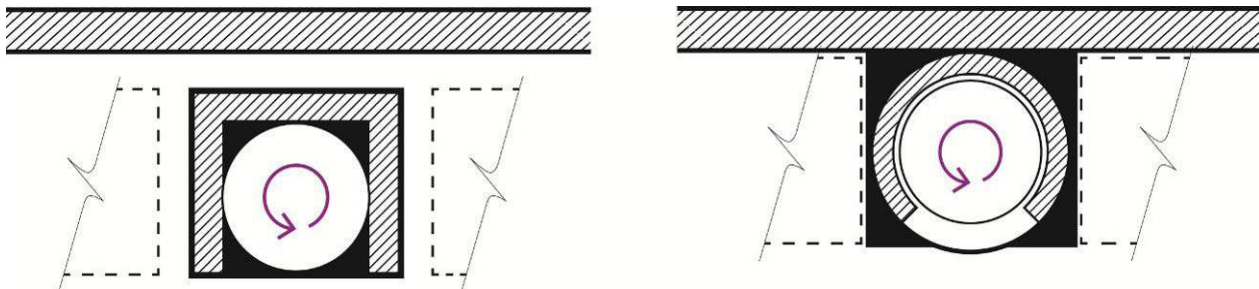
Nutzbarer Innenraum (weiße Fläche) bei eckiger Form (links) und runder Form (rechts)
